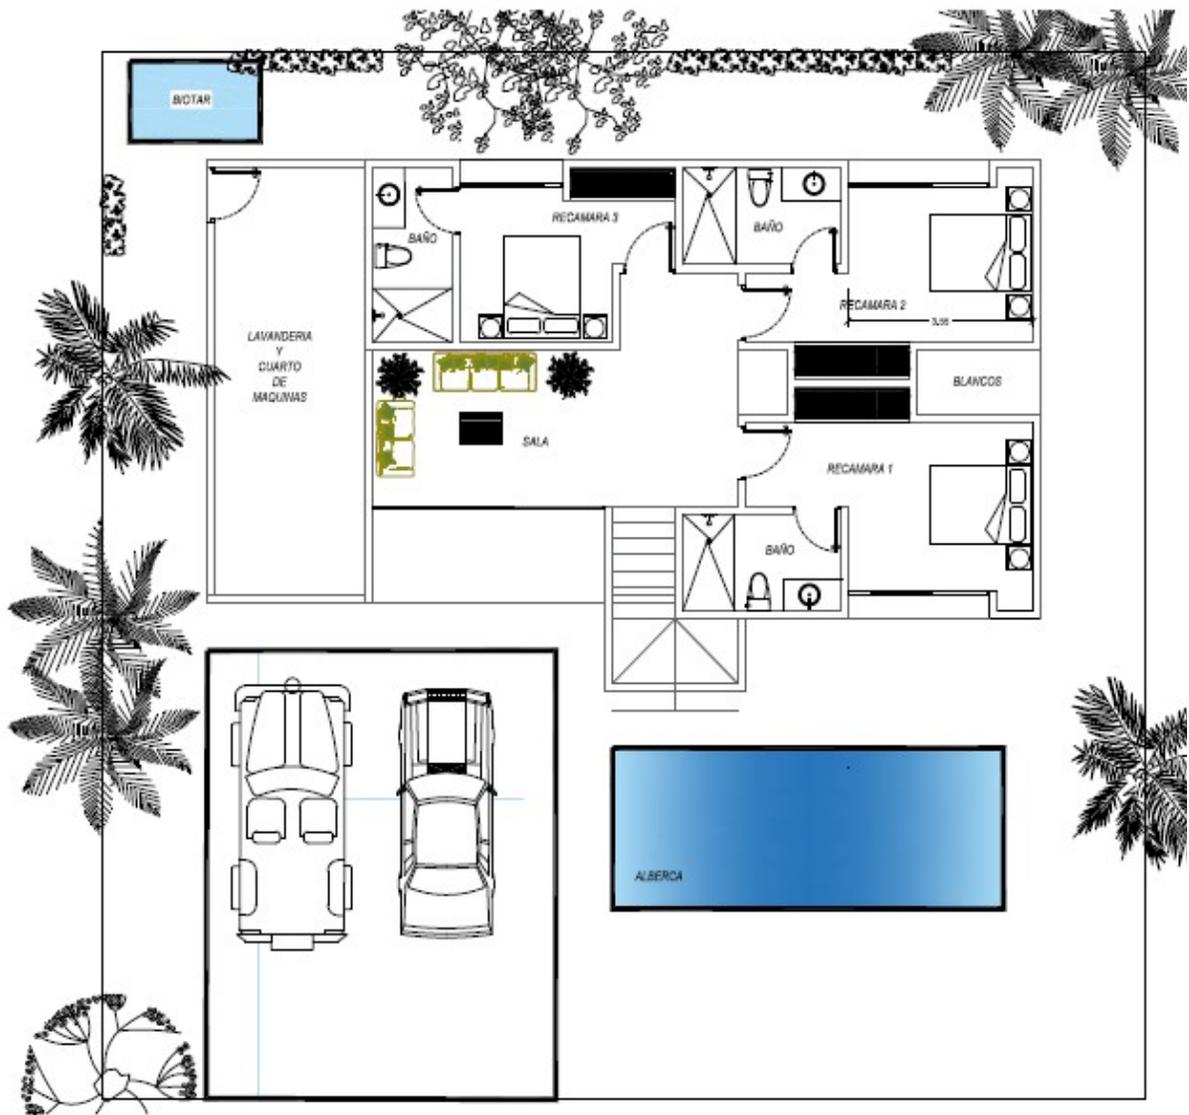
PLANTA DE DISEÑO DE ÁREAS EXTERNAS
